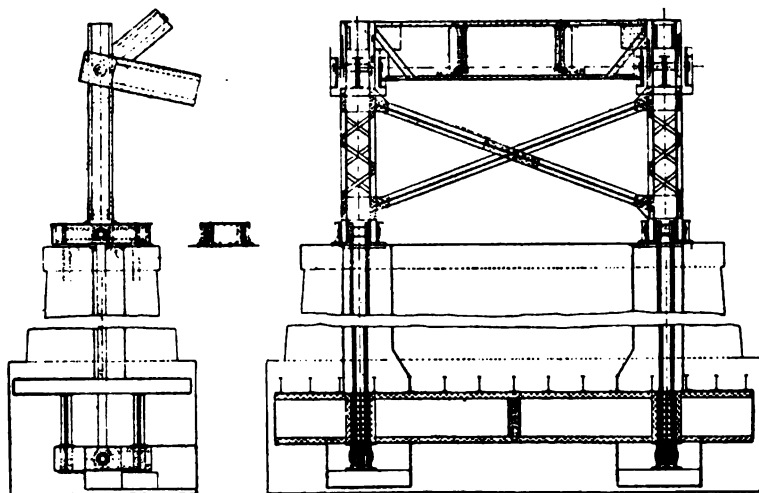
Cadre oscillant et Ancrage du Pont des Aiguilles.
